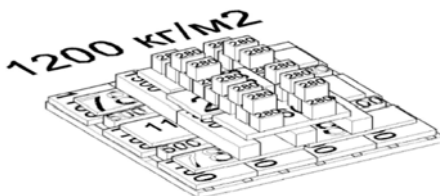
Нагружение плиты перекрытия по 2-ой схеме испытания
